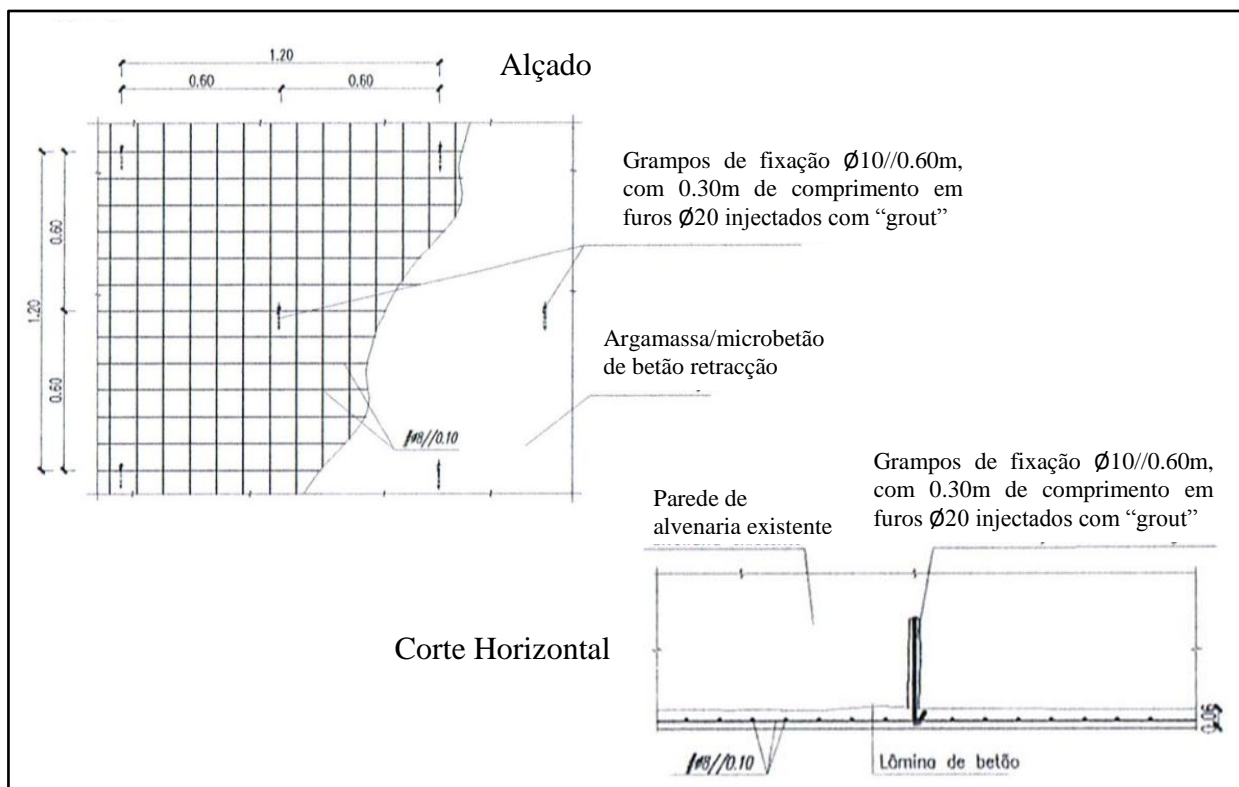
Reparação das paredes com lâmina (com 0,06m de espessura) de betão armado
